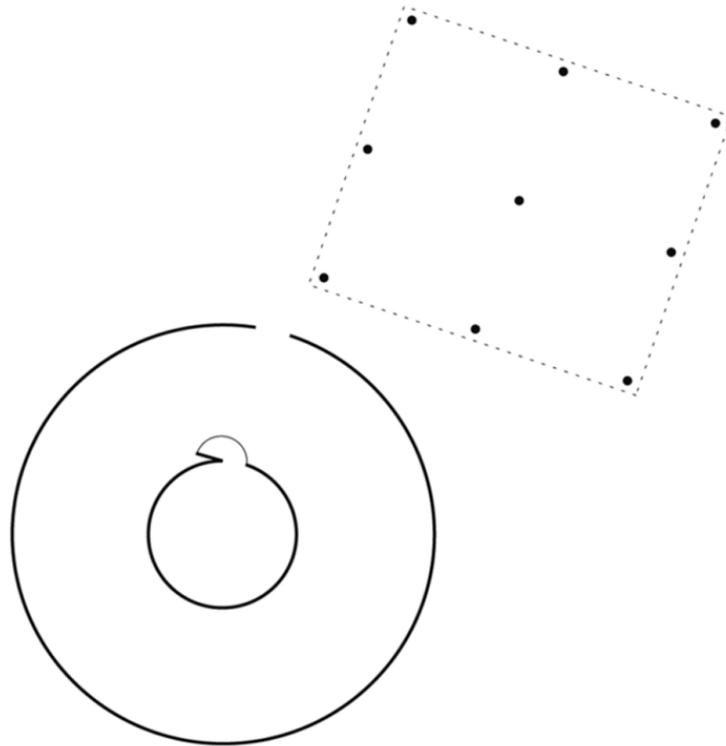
Planta baixa da casa em Niger, 1984. Fonte: Lacaton e Vassal.
